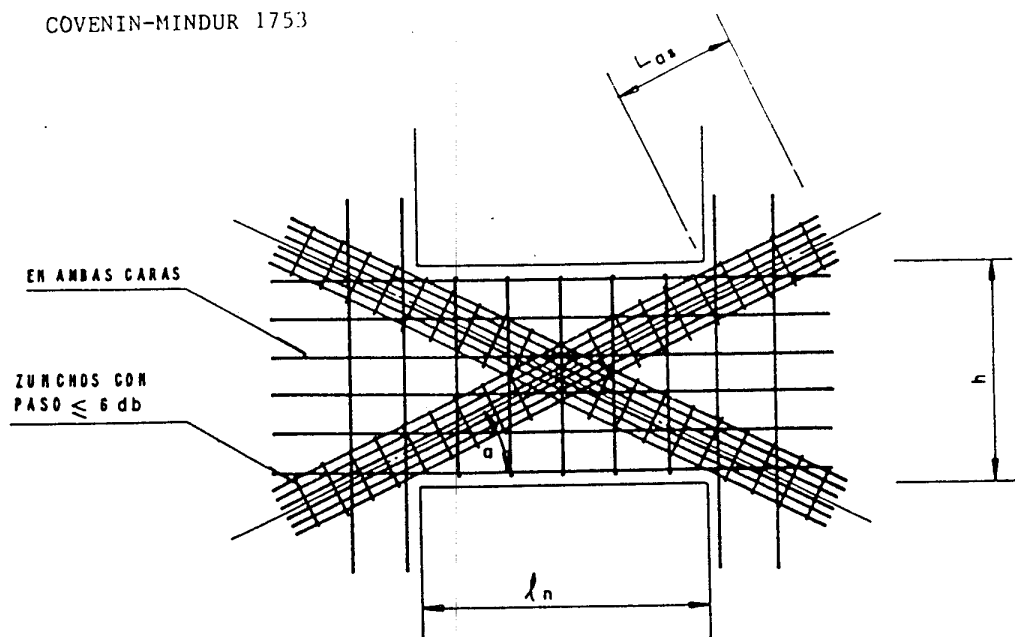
REFUERZO EN VIGAS DE ACOPLAMIENTO PARA MUROS ESTRUCTURALES
